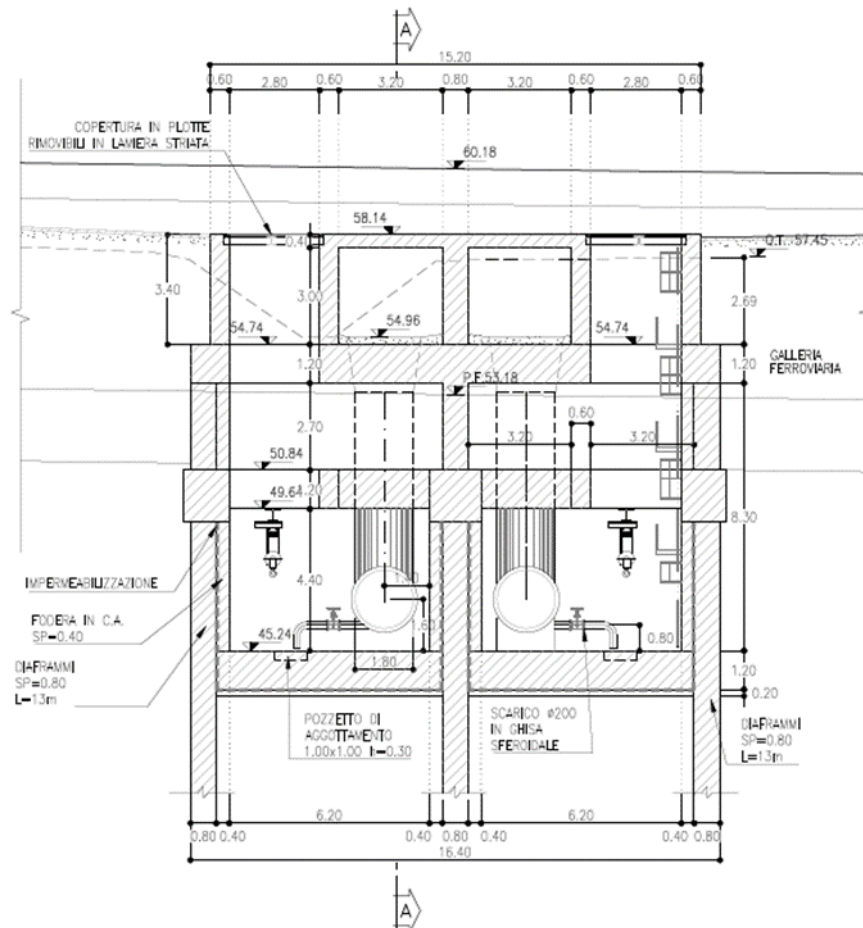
Sezione trasversale IN02 – Sifone Via Cava
